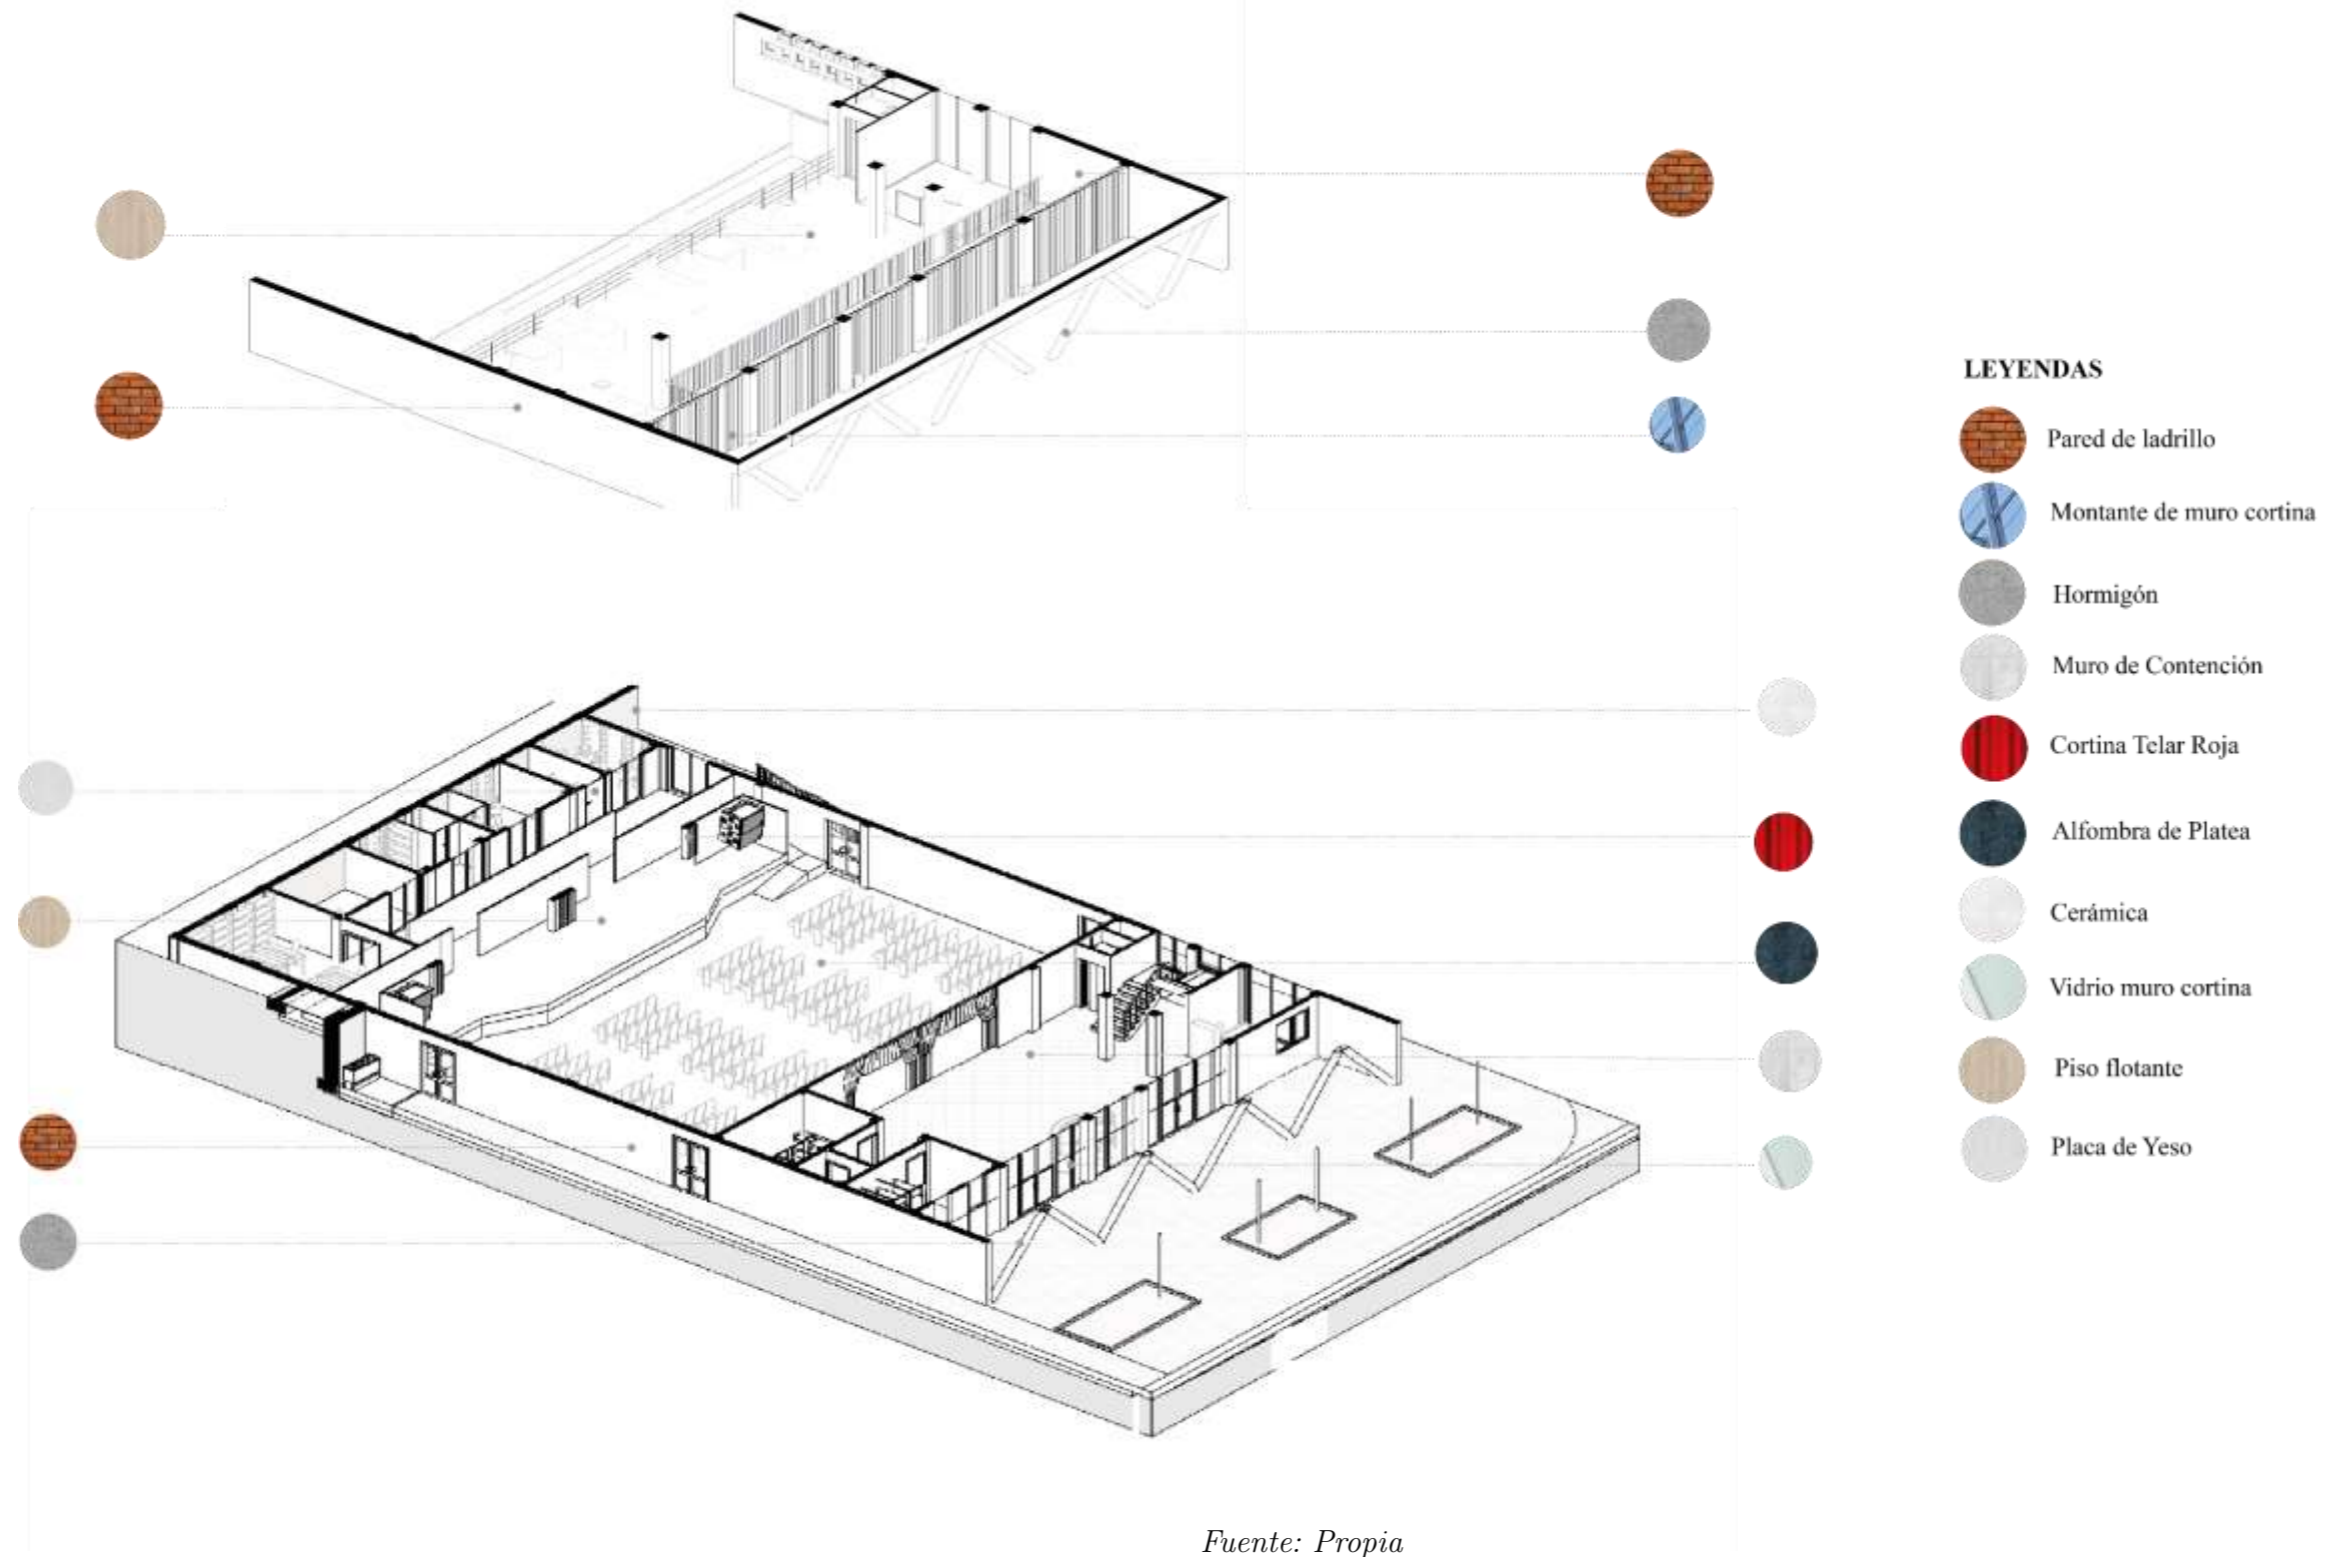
Zonificación de Planta Baja y Alta - Auditorio
